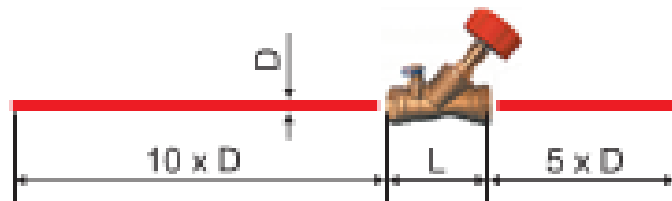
Схема підключення балансувального клапана до трубопроводу
